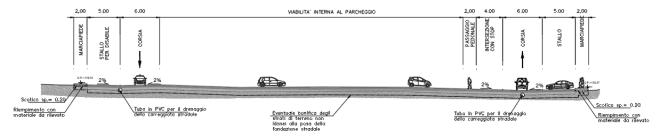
Sezione tipo parcheggio lungo la viabilità interna
